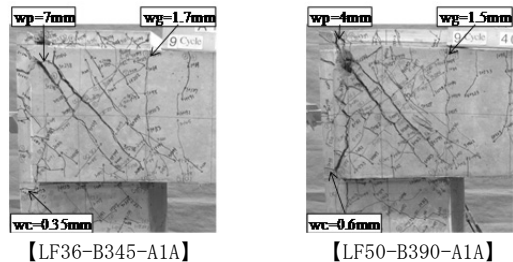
系列IIIのひび割れ状況 (R=40×10<sup>-3</sup>rad時)
